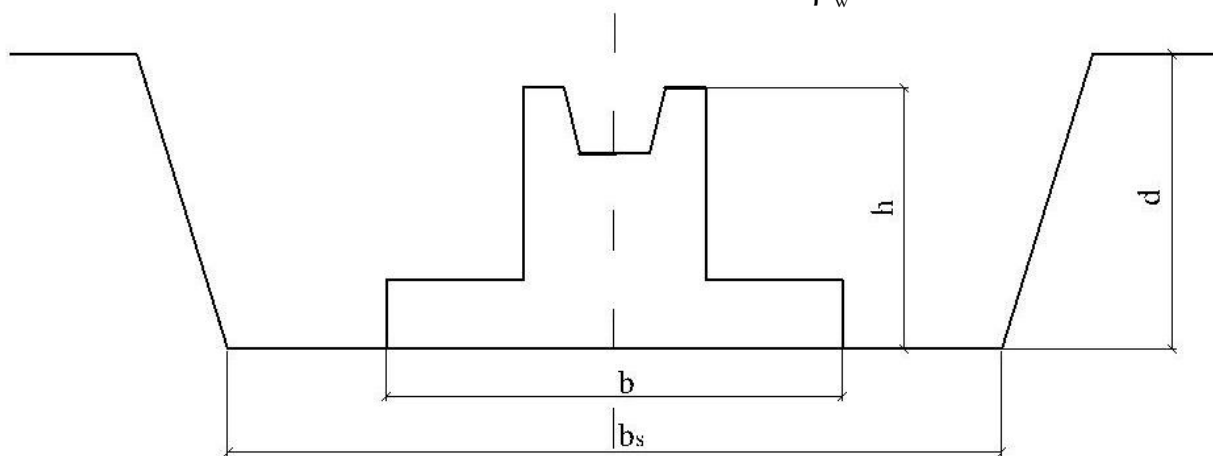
Фундамент на попередньо ущільненому ґрунті
